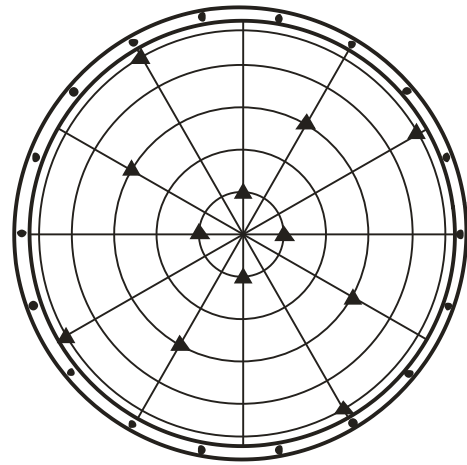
Составная круглая пластина на испытательном стенде
